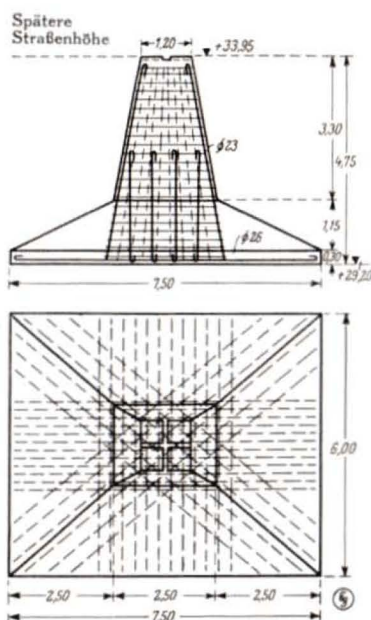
Eisenbeton-Fundament für einen Portalfuß zwischen Siemensdamm und Holtzdam
